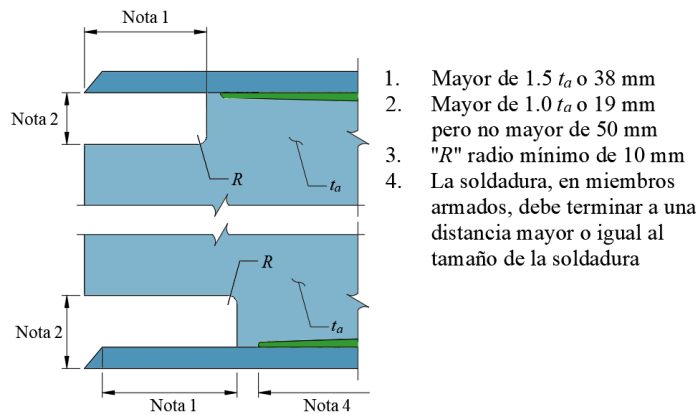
Detalle de agujero de acceso en miembros armados
